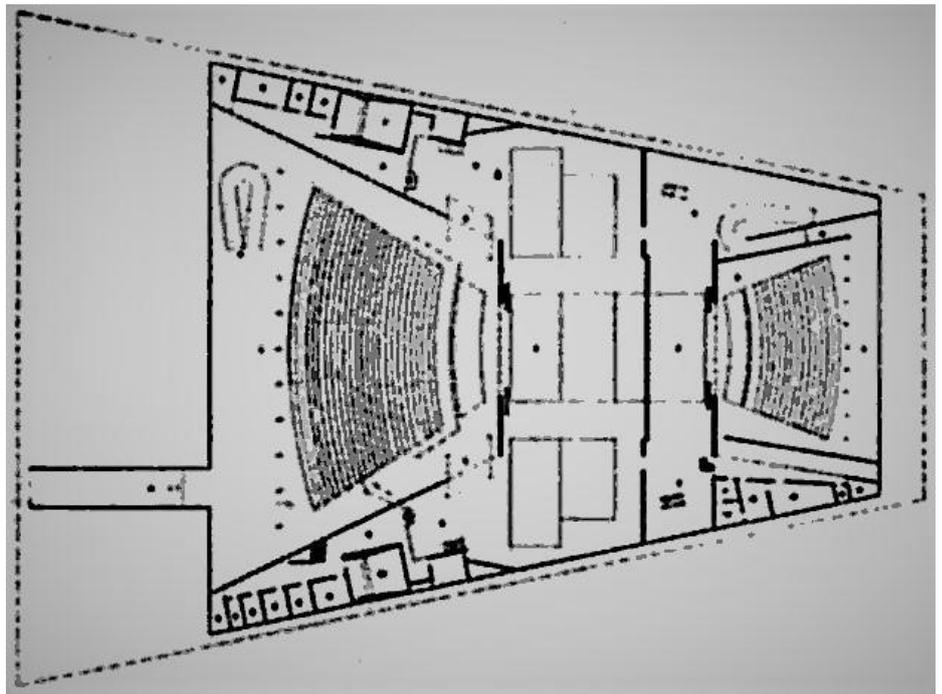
Croqui - Planta baixa do Teatro Nacional de Brasília, Niemeyer. Fonte. Revista Projeto.
